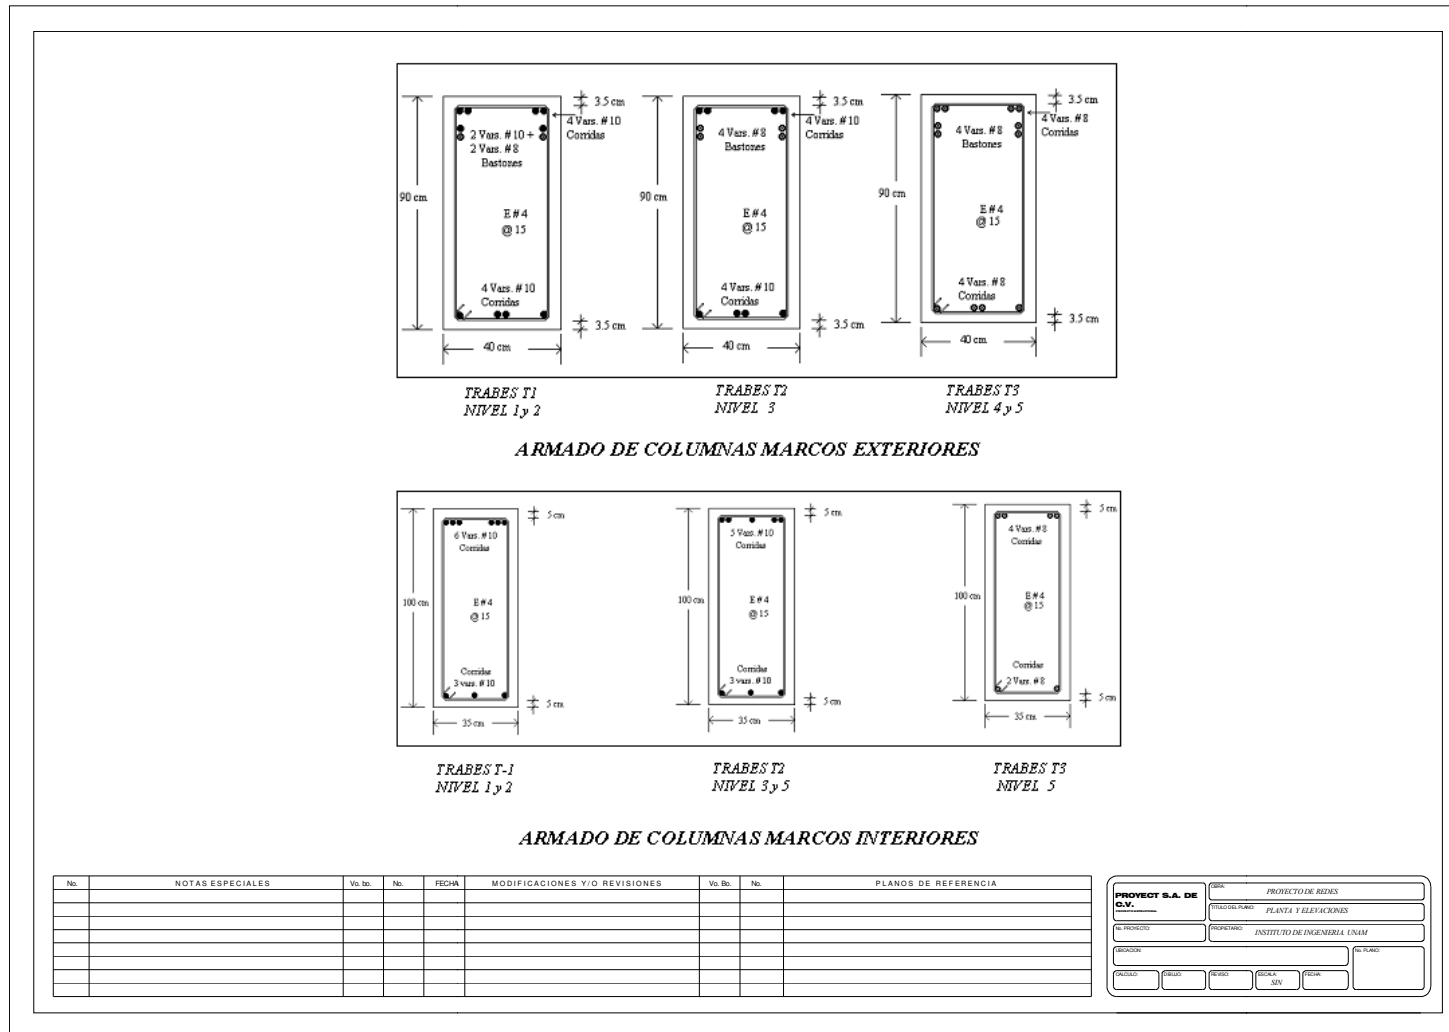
Secciones estructurales del edificio de 5 niveles
